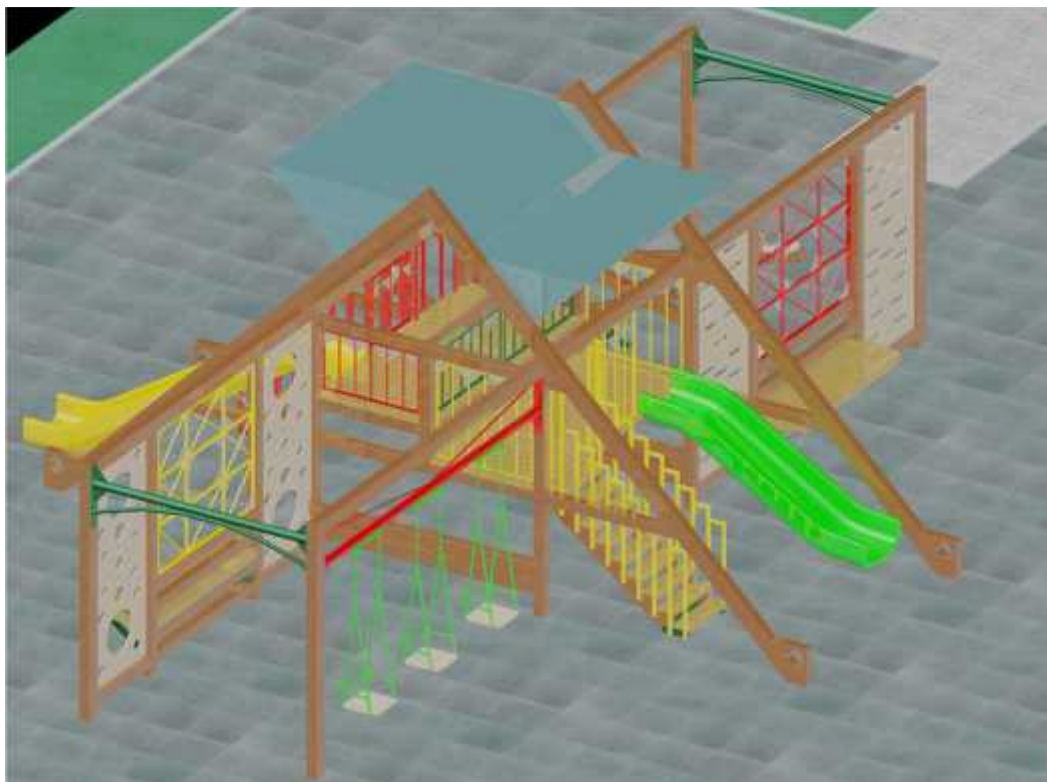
Pamjet e hapësirave të parapara për fëmijë
